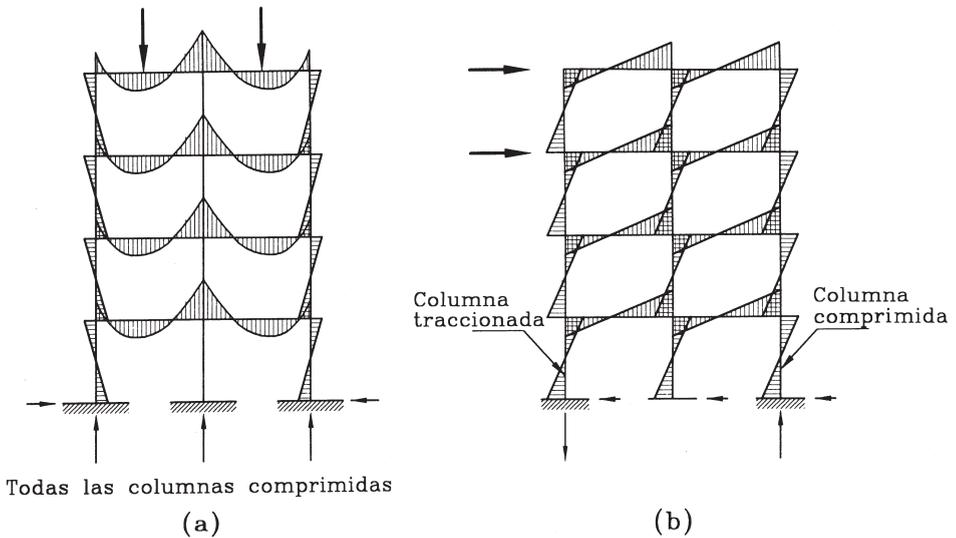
Diagramas de momento flector para una estructura de pórticos: a) Cargas verticales, b) Cargas horizontales
